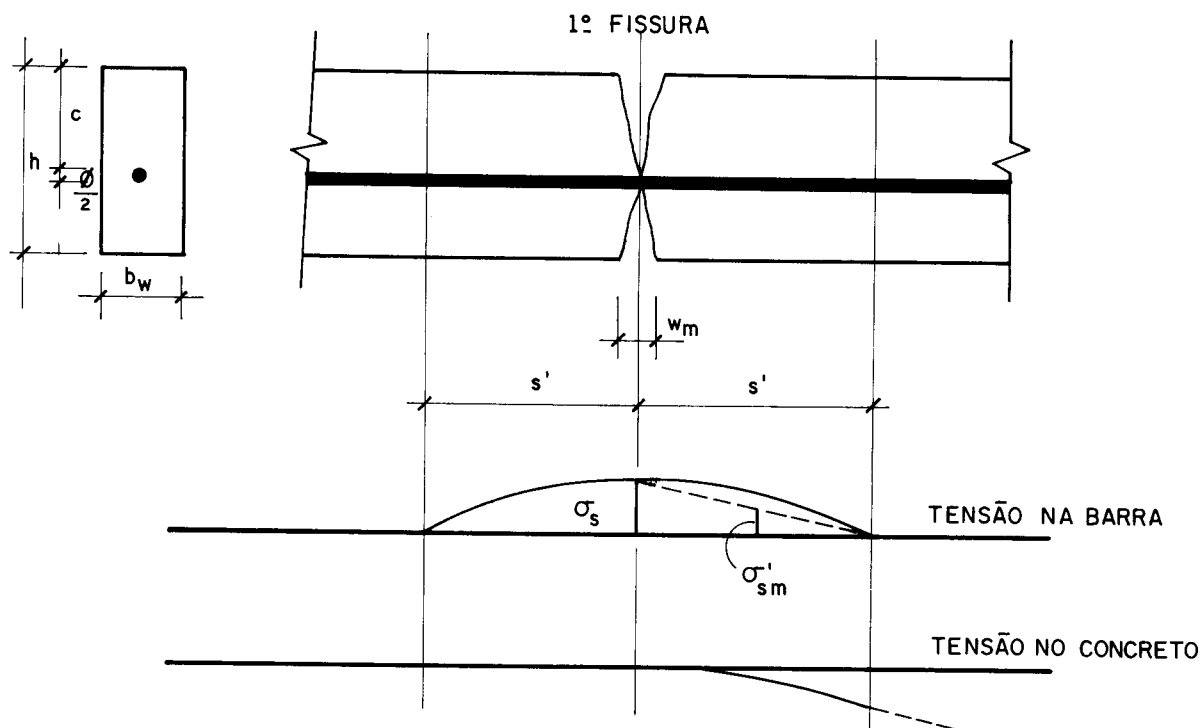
FISSURAÇÃO ASSISTEMÁTICA
